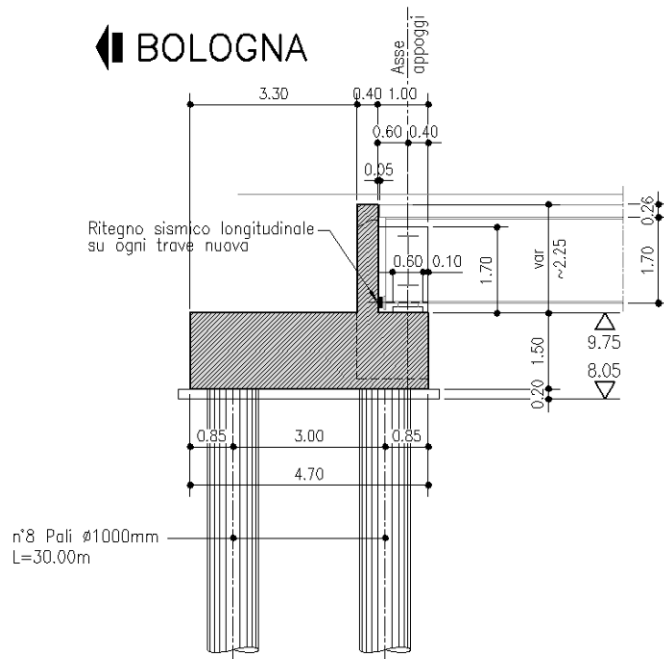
Sezione longitudinale spalla in ampliamento
